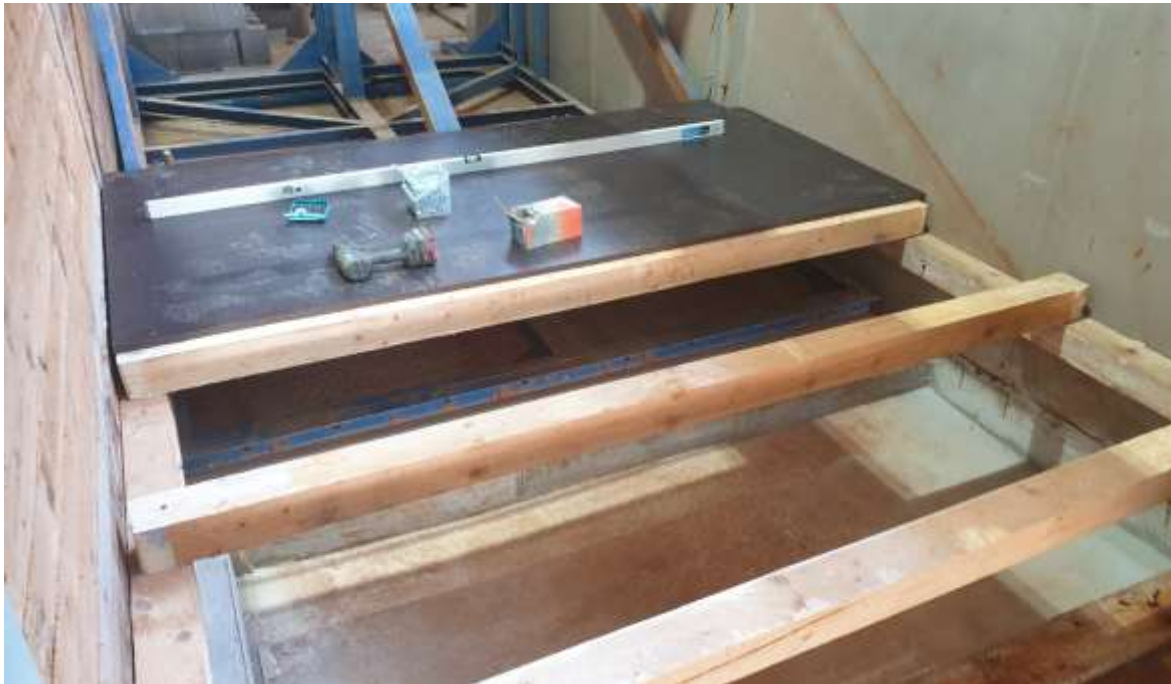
AgF - Grundgerüst Sohle Wellenkanal
